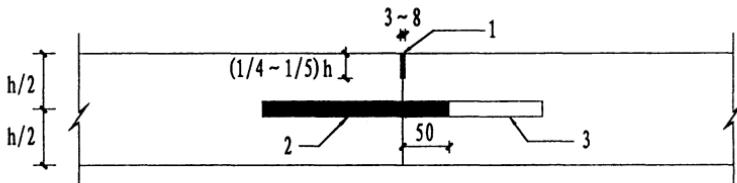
设传力杆平缝型横向施工缝构造(尺寸单位:mm)
